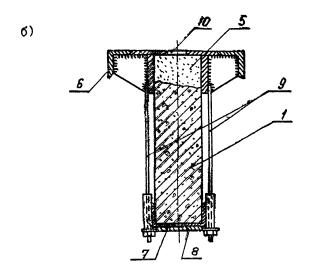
Усиление свесов полки железобетонных подкрановых балок
